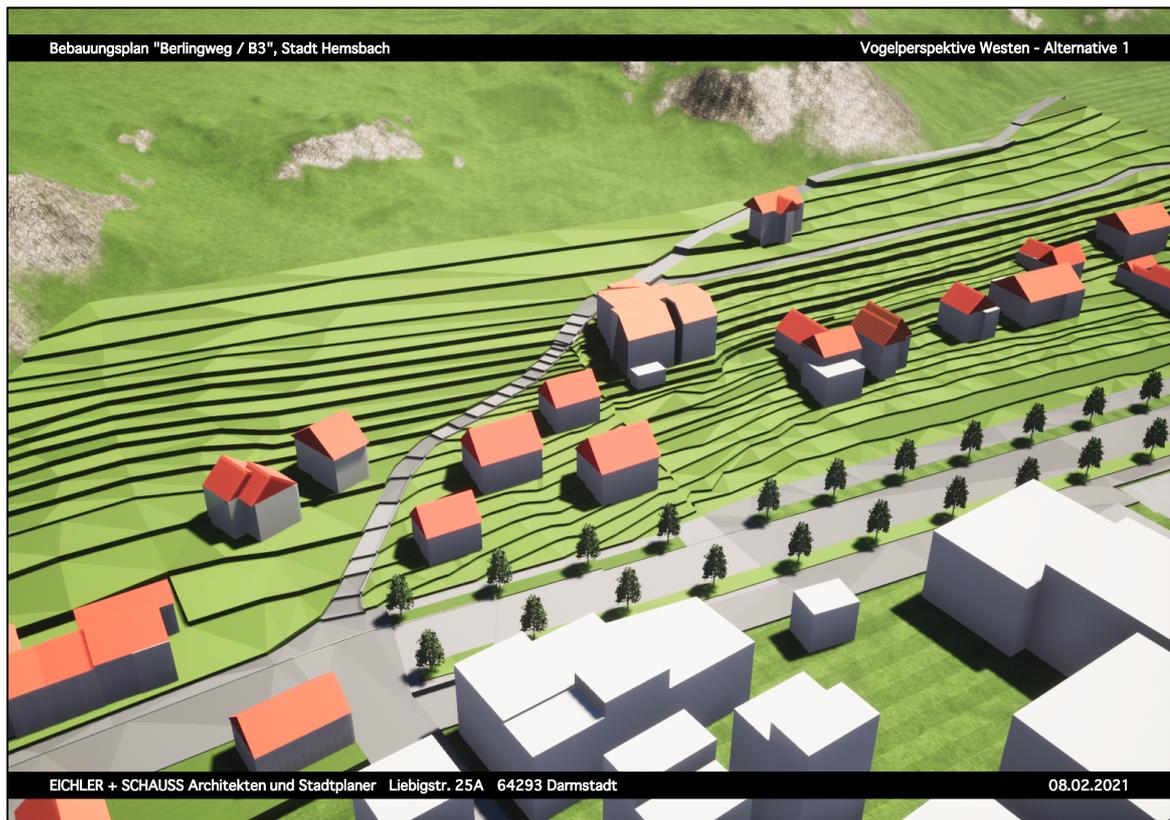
Visualisierung des Städtebaulichen Entwurfs "Berlingweg - B 3", 08.02.2021, Eichler + Schauss, Darmstadt
